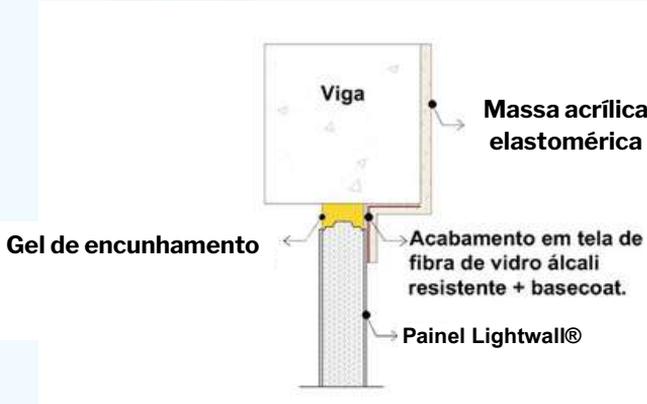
Tratamento de juntas, em local visível, na interface do painel Lightwall® entre viga e laje.
